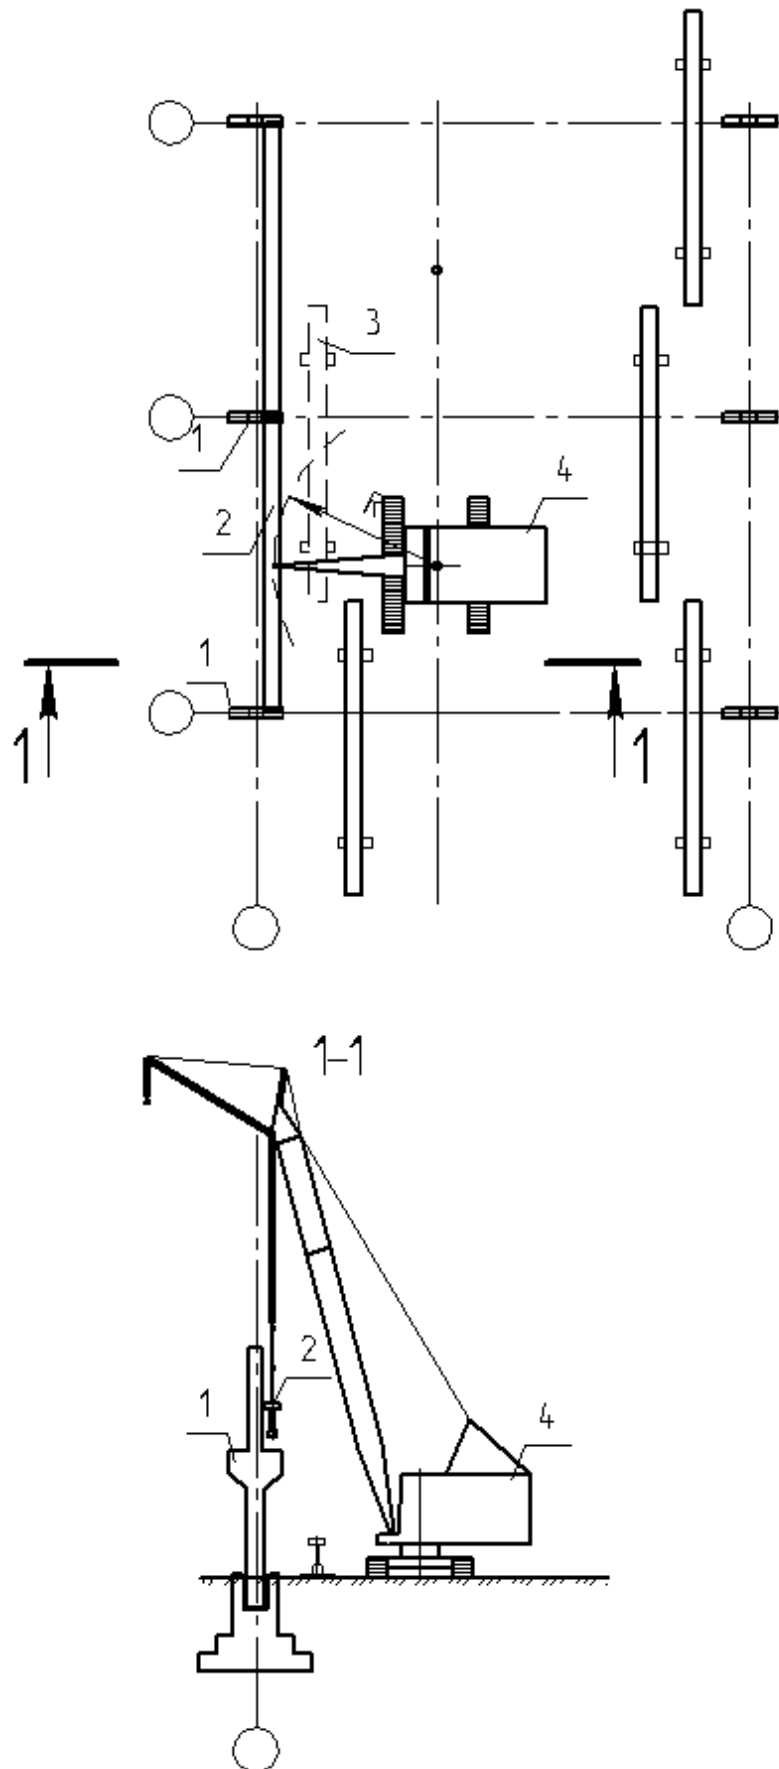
Схема монтажа подкрановых балок одноэтажного промышленного здания: 1 – железобетонная колонна; 2 - железобетонная подкрановая балка; 3 - склад железобетонных элементов; 4 - стреловой грузоподъемный кран
